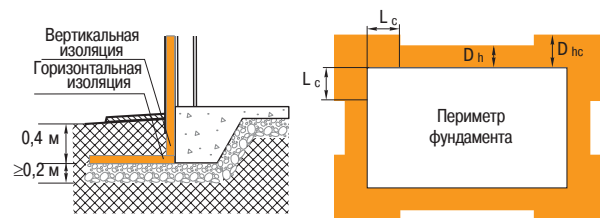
Поперечный разрез и план расположения изоляционных плит «Пеноплэкс®» для отапливаемых помещений при $R_f=0$
